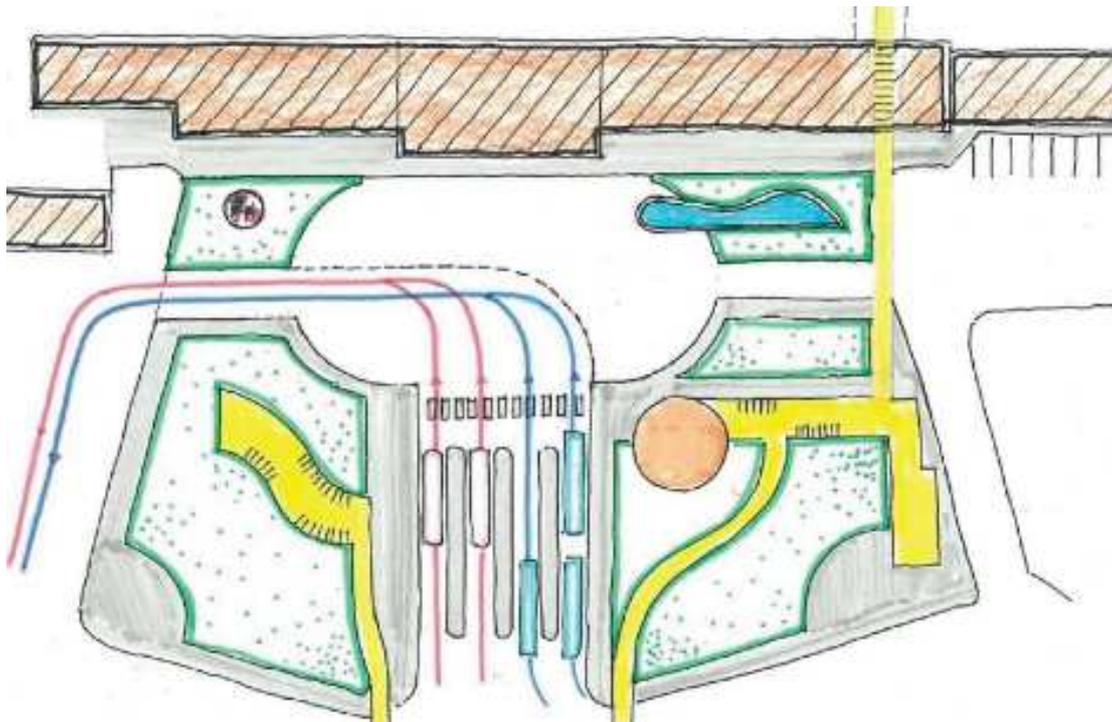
Ipotesi nuovo assetto di Piazza della Stazione (particolare area centrale)⁴
